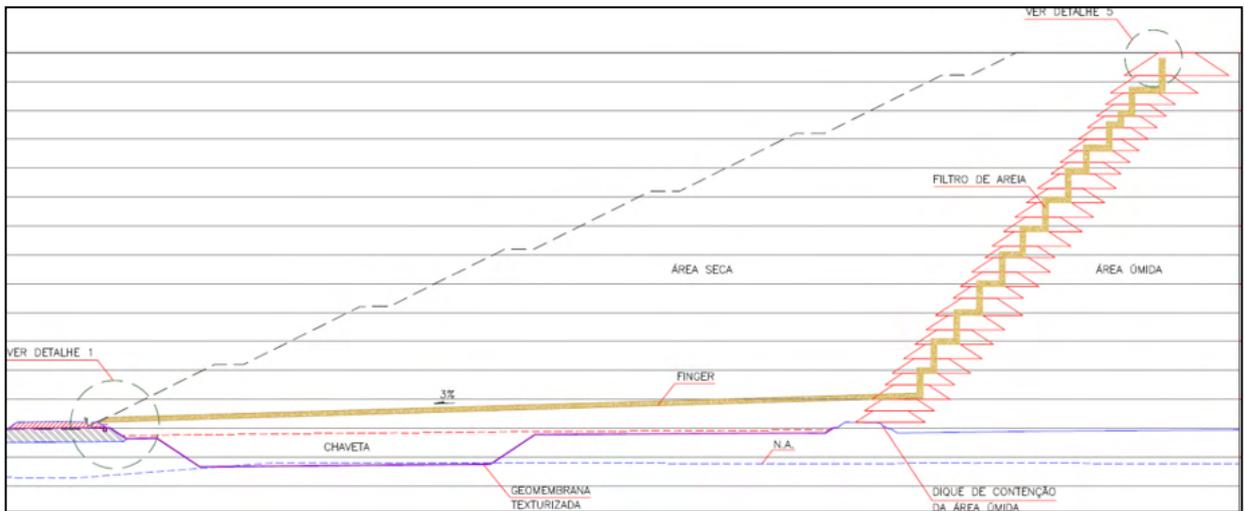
Seção Típica – Drenagem interna da pilha (documento D1-3541-54-G-163)
